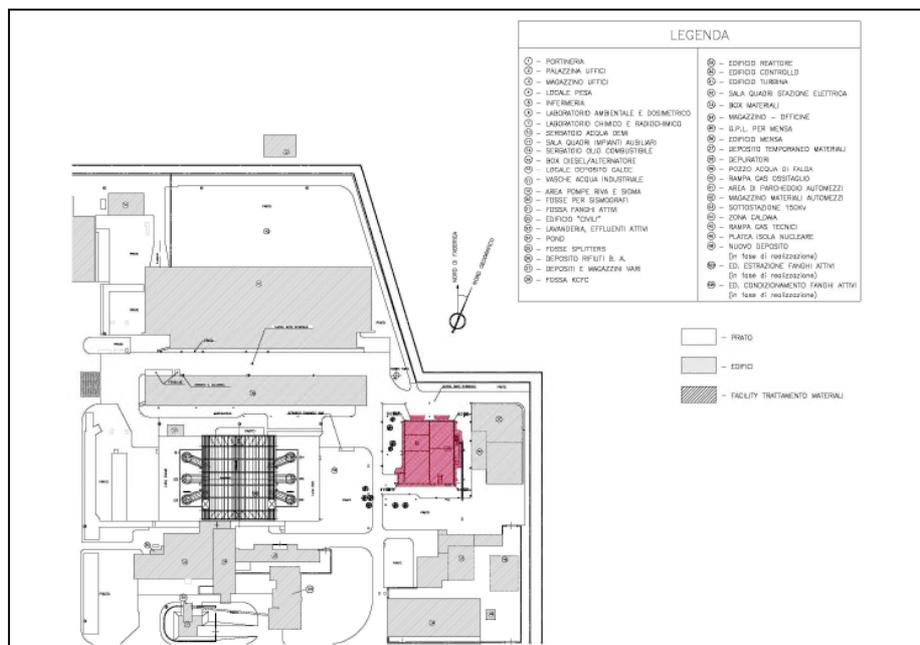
Ubicazione dell'Edificio della Facility all'interno dell'impianto.
